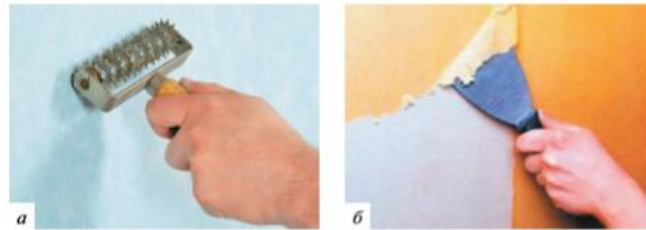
Инструменты и приспособления для снятия старых обоев: а — игольчатый валик; б — скребок-шпатель
